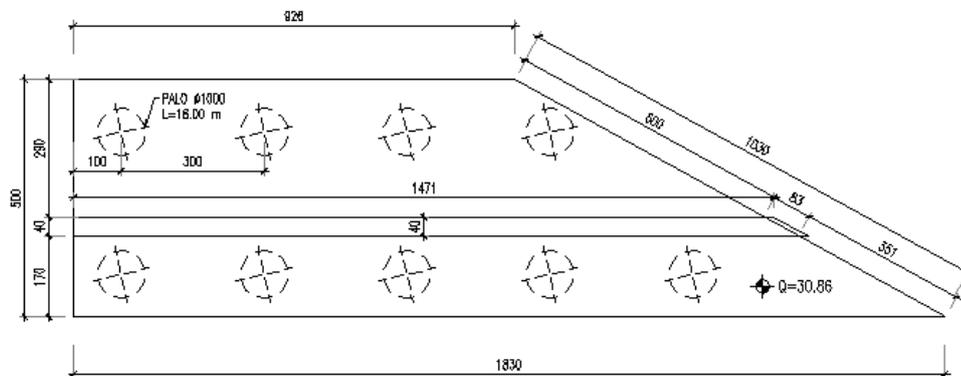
Planimetria fondazioni e prospetto muro contenimento lato Spalla 1 dx
